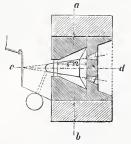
Grundriß nach gh. Doppel=Schachtofen.
